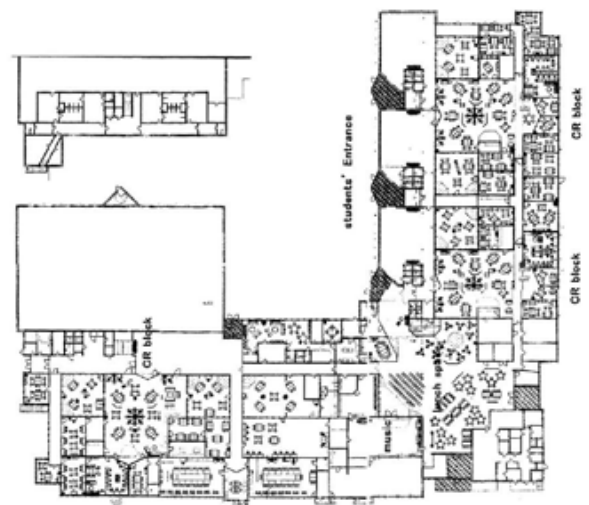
フューチャラム基礎学校（スウェーデン）の平面図
